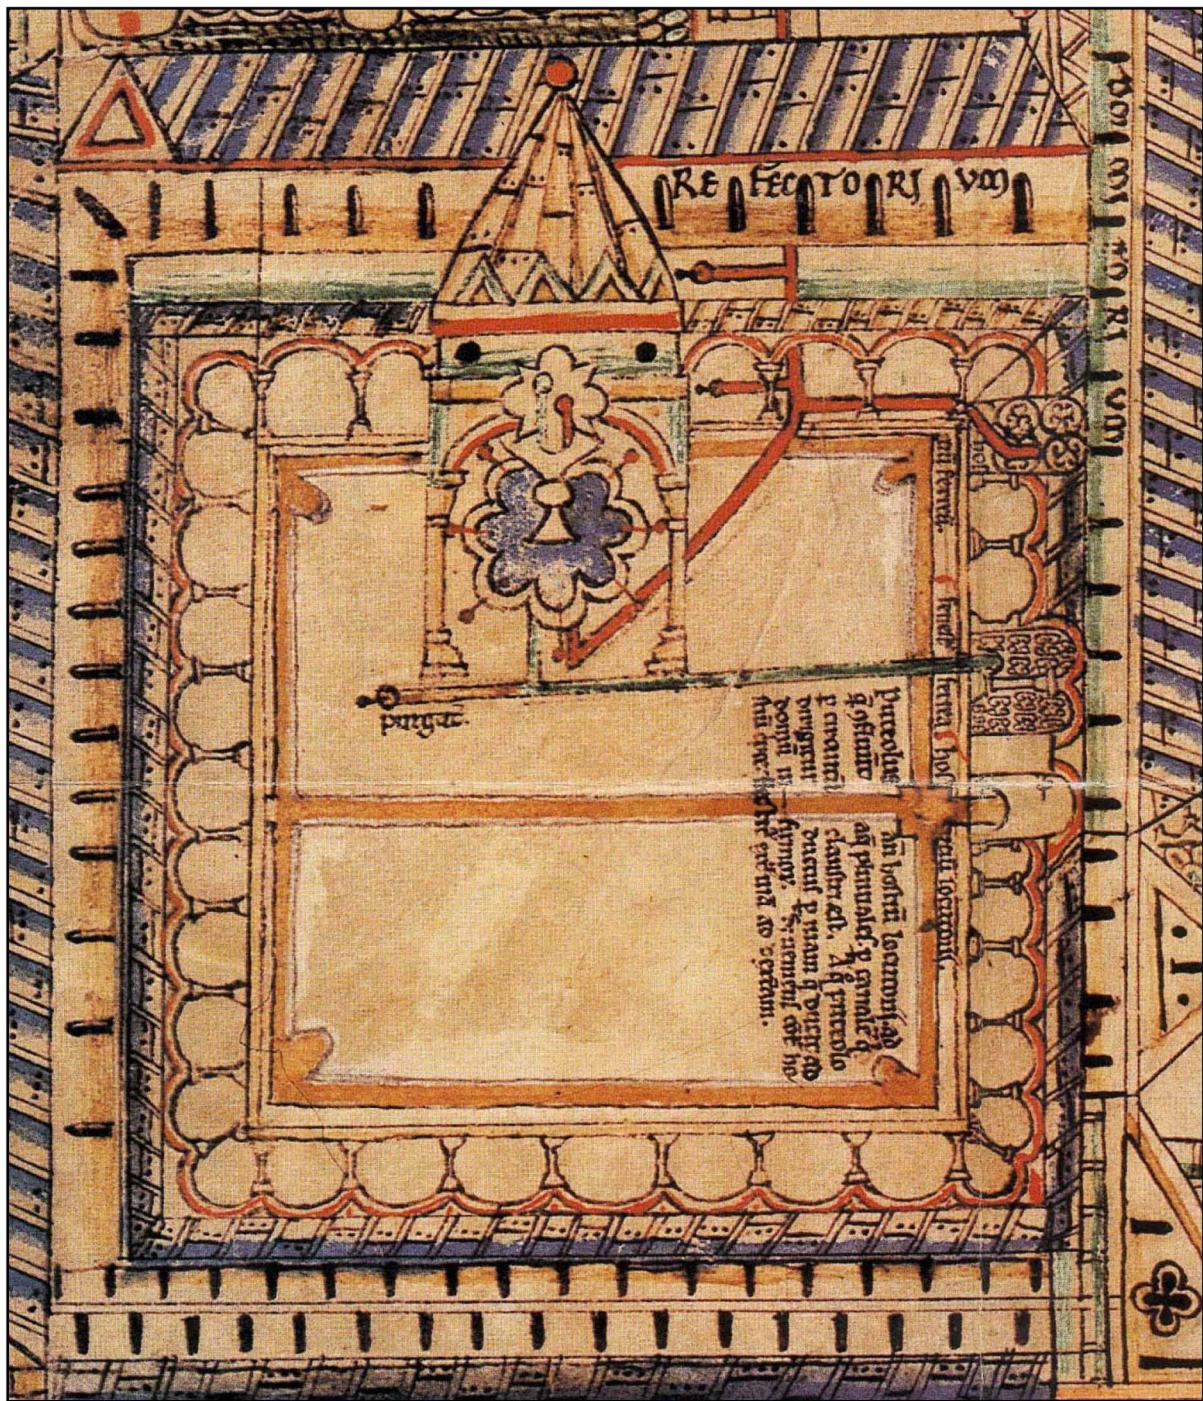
Plan de Cantorbéry, Le cloître et son lavabo.
